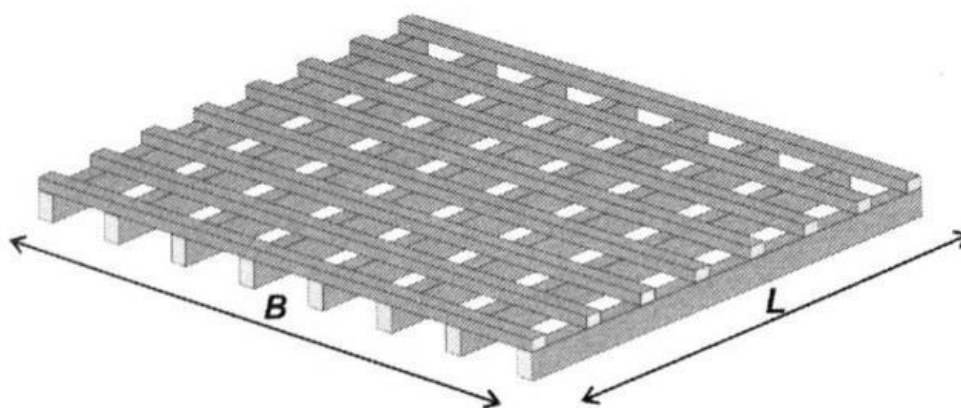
Sistema estrutural de um pavimento de madeira (Negrão e Faria, 2009)
